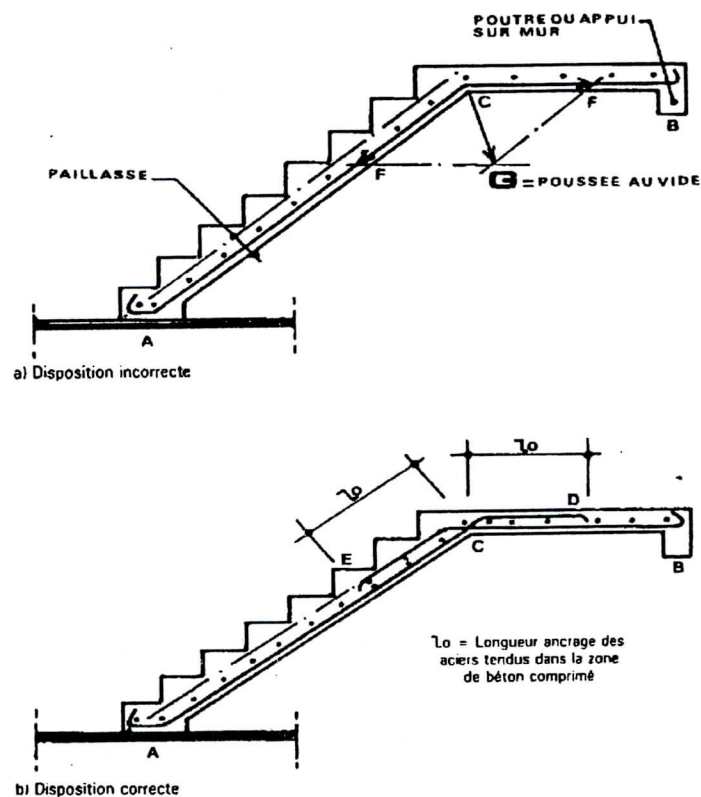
Ferrailage d'une volée d'escalier [1]
